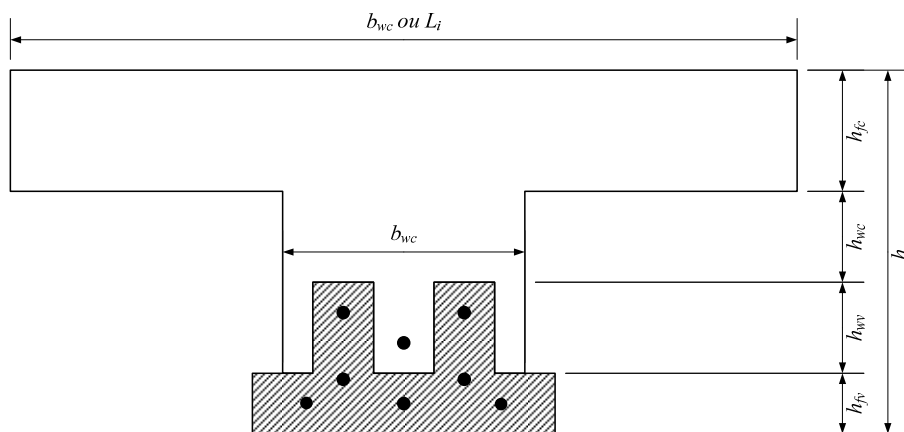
Definição da geometria da laje de betão complementar no caso de vigota em π invertido
